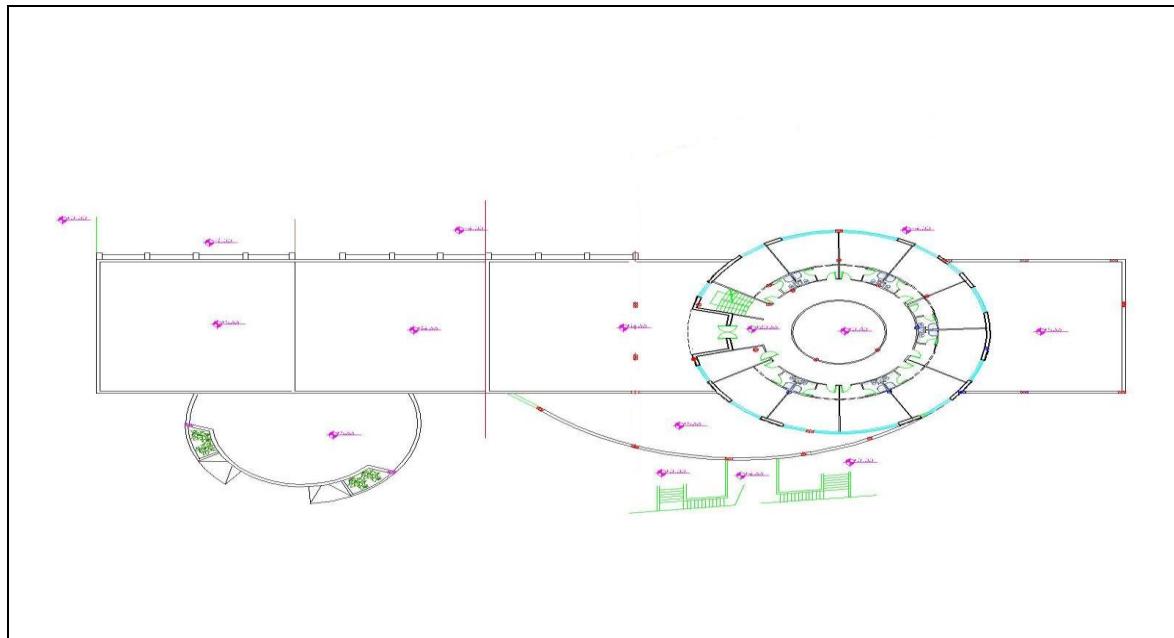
صوره لمسقط الطابق الثاني .
